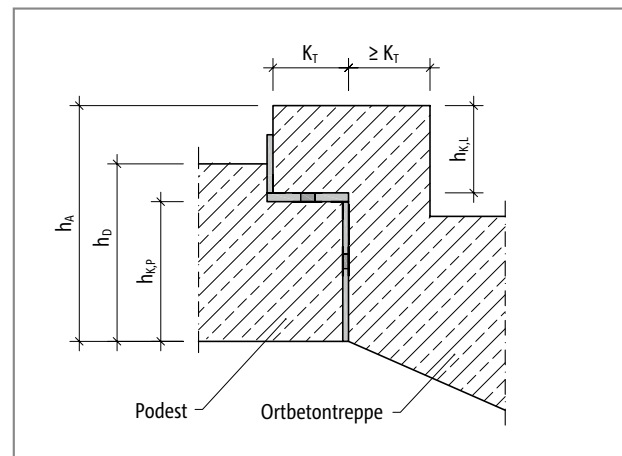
Schöck Tronsole® Typ BZ...XL: Bemessung
